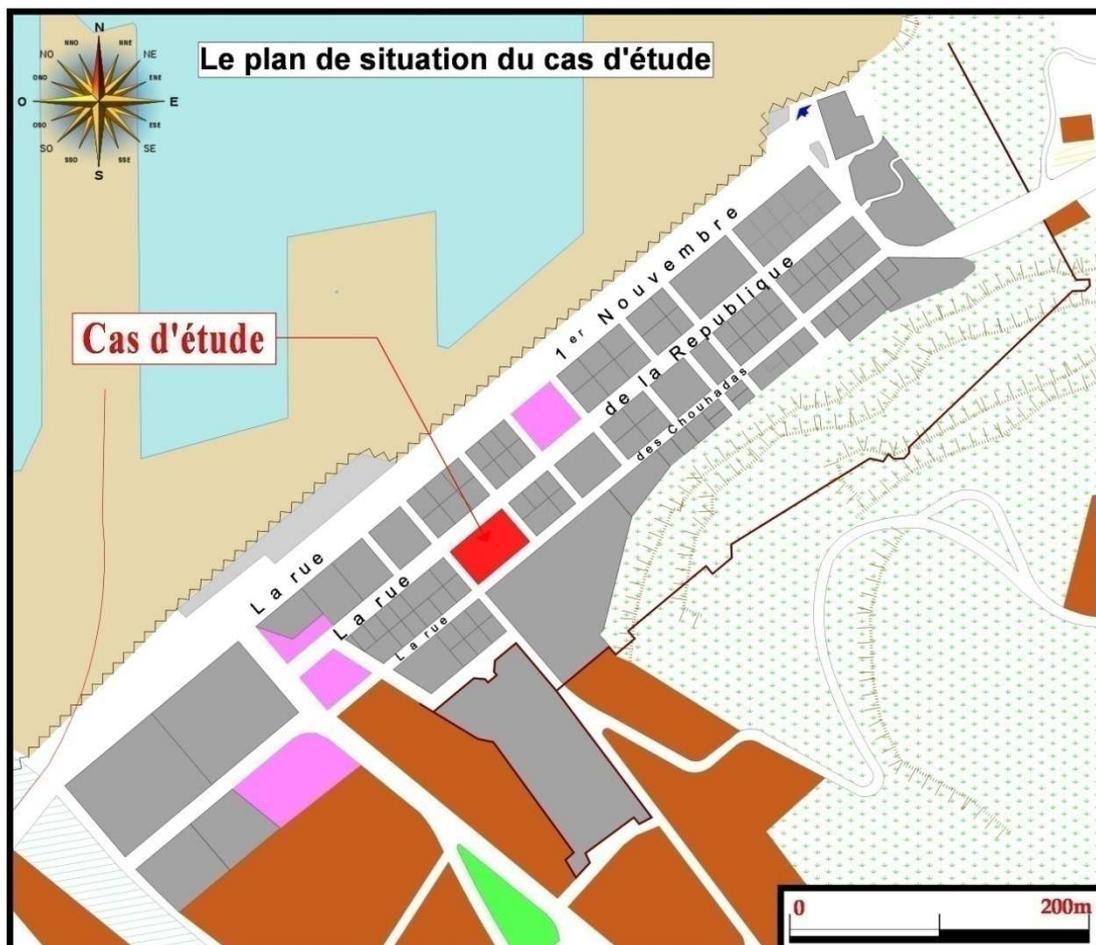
Plan de situation l'hôtel de ville, source : l'auteur.
